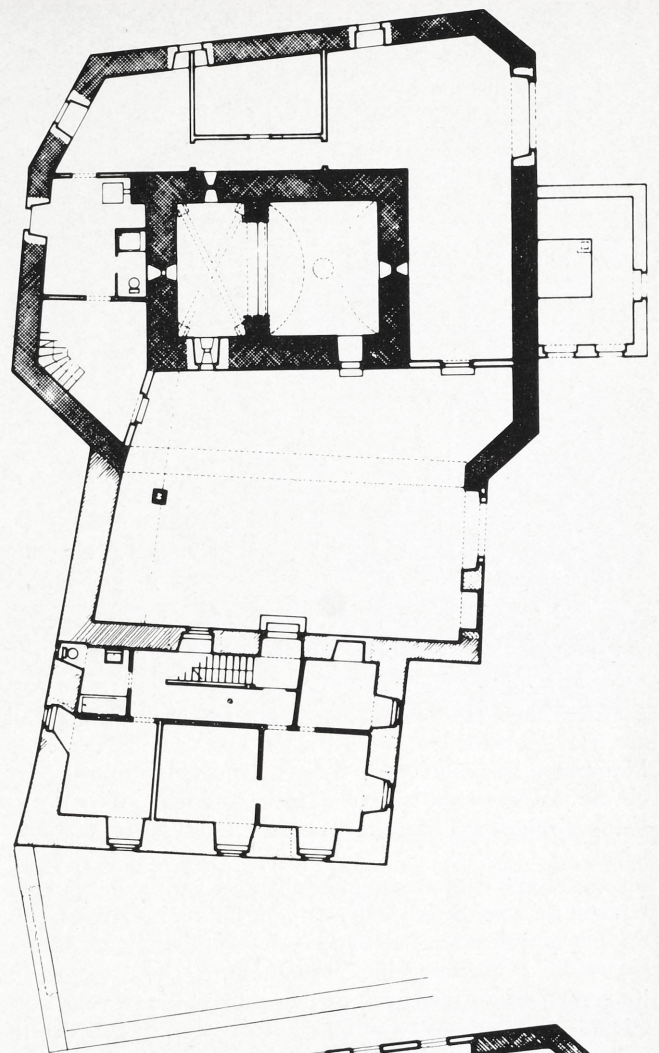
Schloß Tullau, Grundriß vom Erdgeschoß nach der Erneuerung
